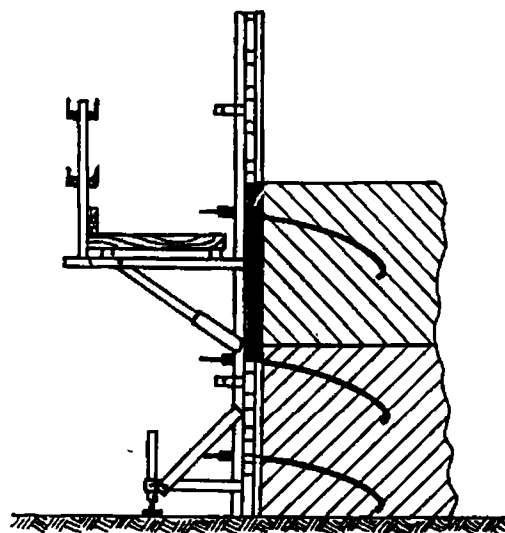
Montarea cofrajului pășitor CP 100 la elemente de construcții din beton.
